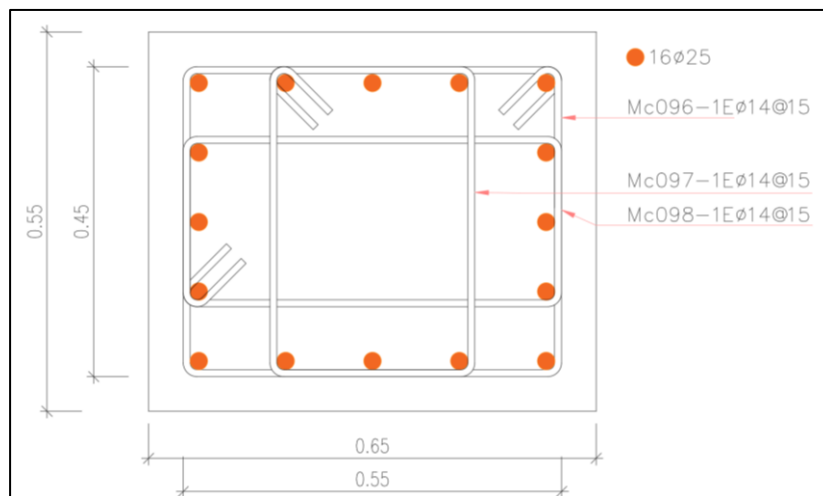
Diseño definitivo de la columna. Fuente: Autor
